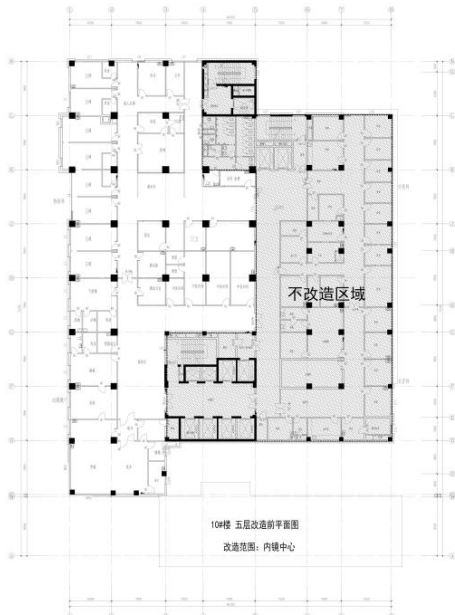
10 号楼 5 层改造前平面图 图 5-16 10 号楼 5 层改造后平面图
